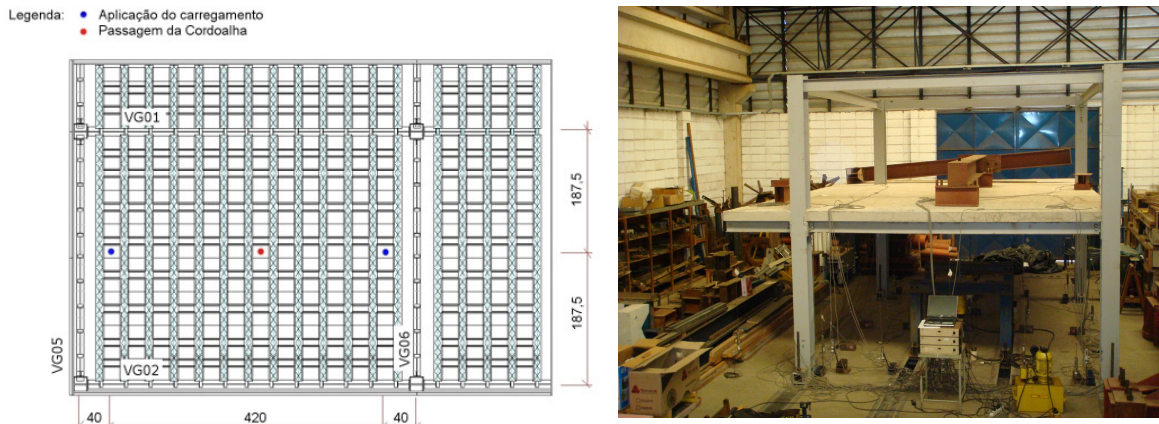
Esquema da posição de aplicação do carregamento e vista da estrutura - 4ª etapa de carregamento concentrado
